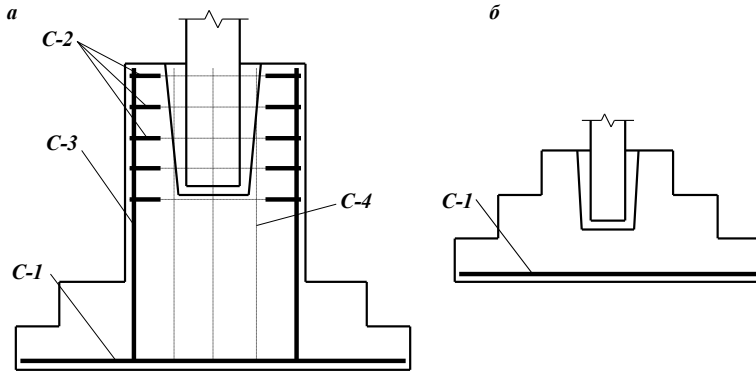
Окремі позацентрово завантажені фундаменти під колони
